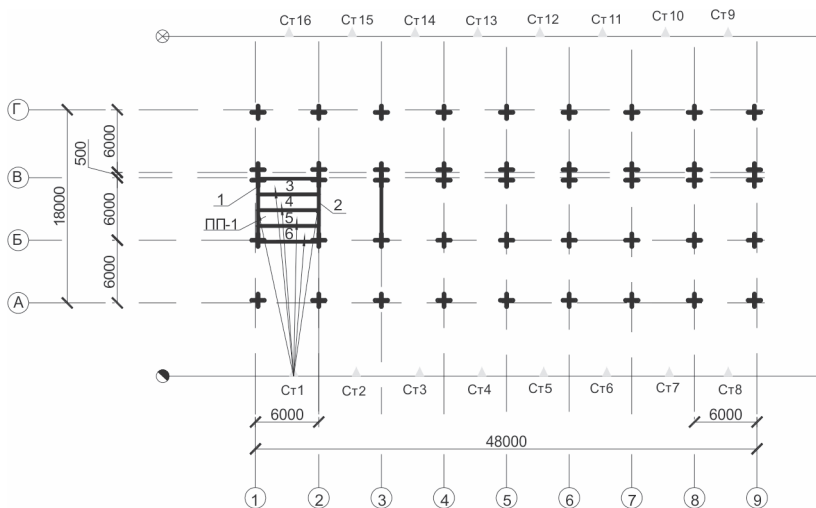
Схема проходки крана в процессе монтажа элементов покрытия
